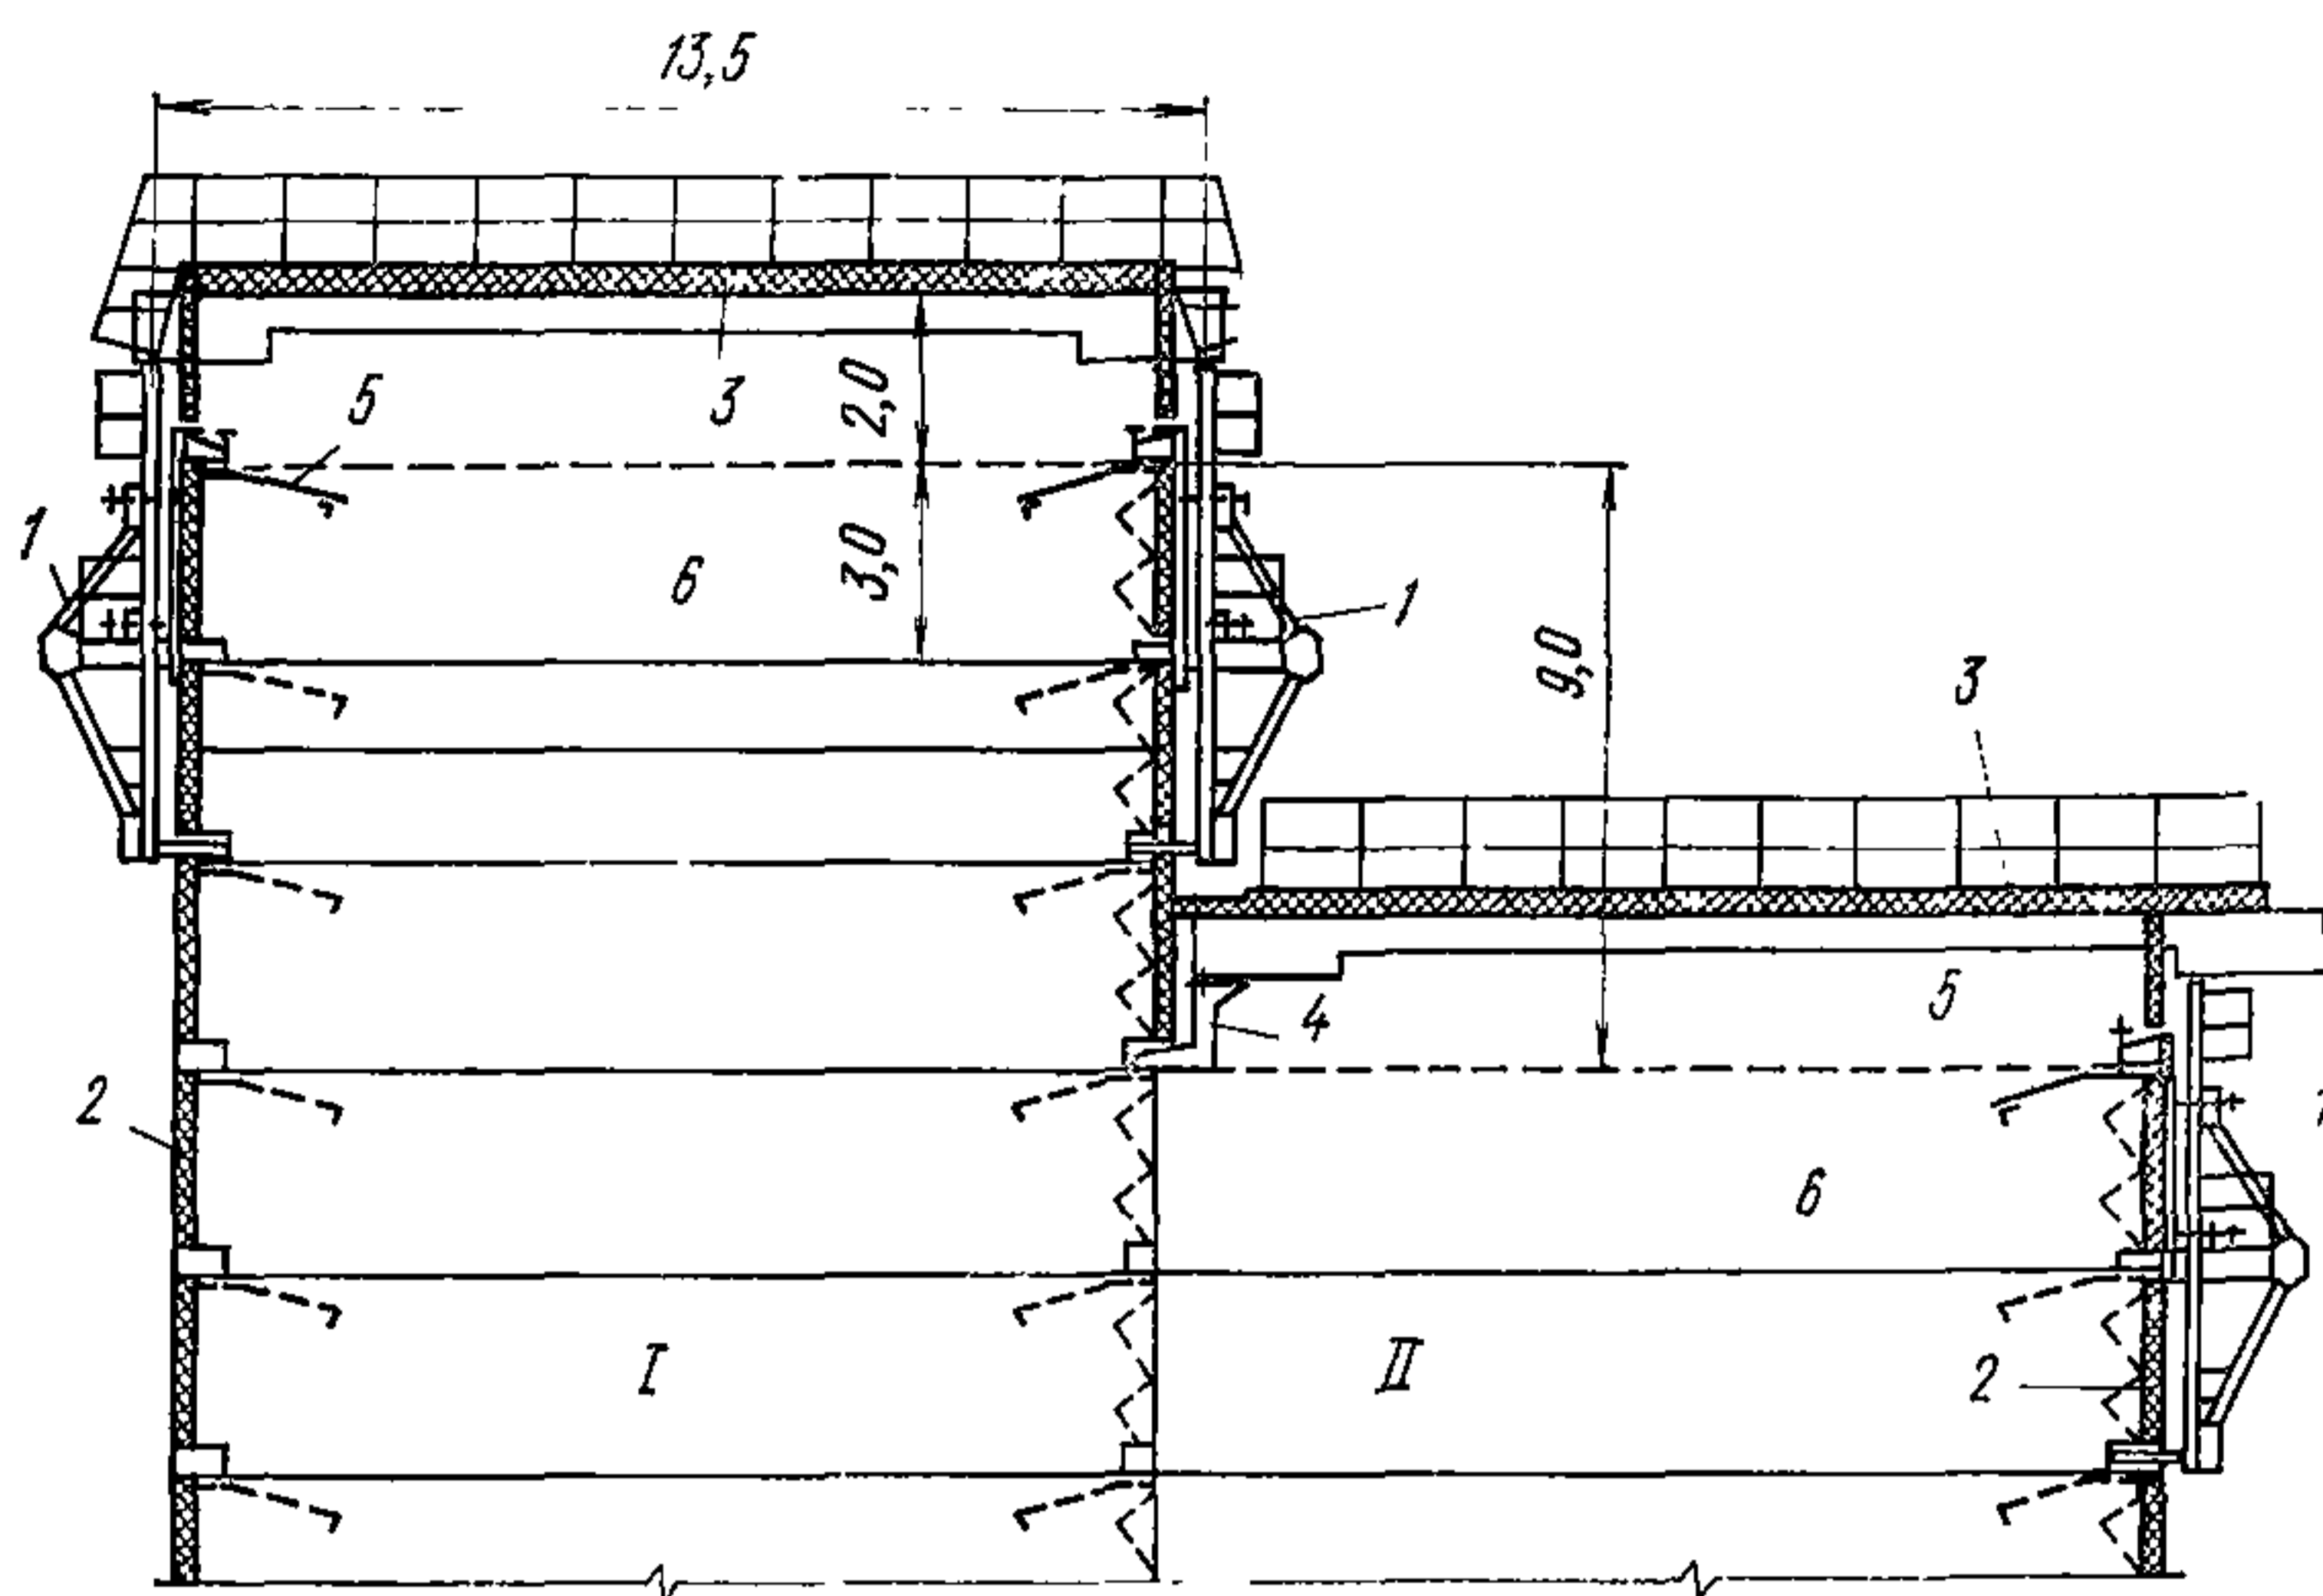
Схема бетонирования блоков плотин в опалубке УК-18 в зимних условиях
